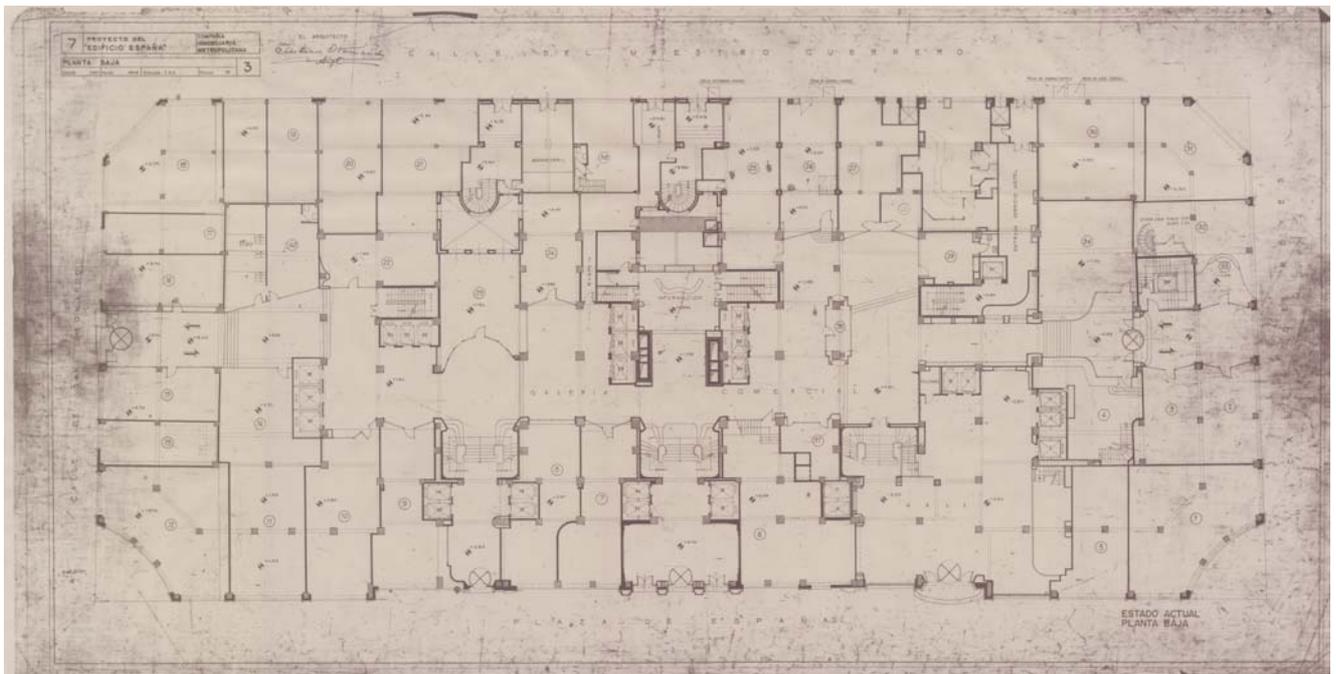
Planta baja con la galería comercial, 1949. Arquitecto: Julián Otamendi. (Servicio Histórico COAM, JOM_P67_T03_04)
